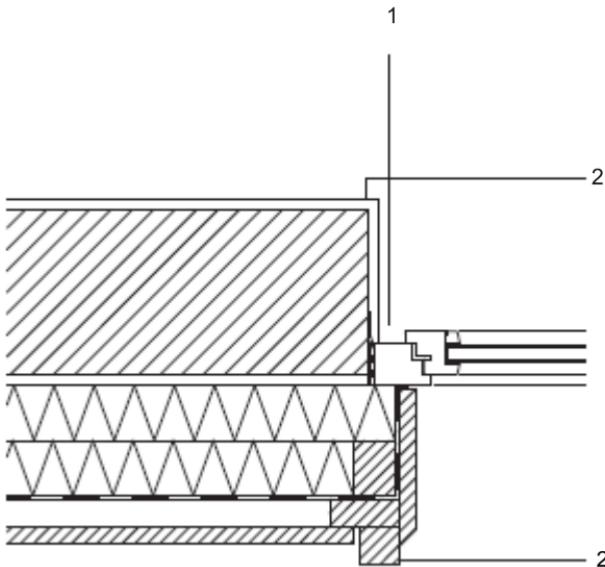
Стык окна с наружной стеной, защищенной навесной вентилируемой фасадной системой (горизонтальный разрез):
